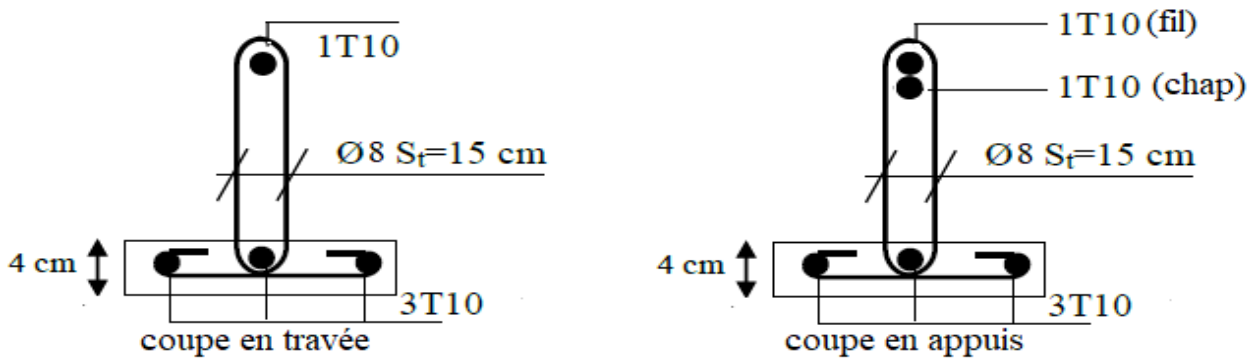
Schéma de ferrailage des poutrelles intermédiaires RDC, étages courant
